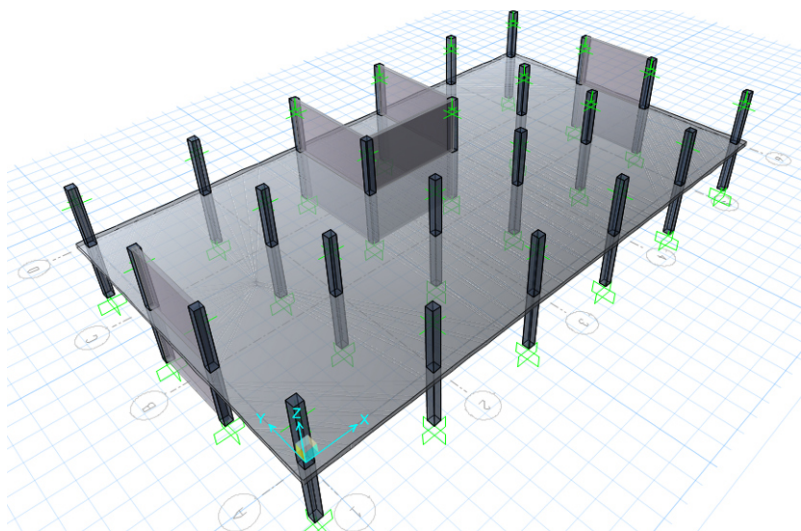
Исходная расчетная схема монолитного перекрытия
